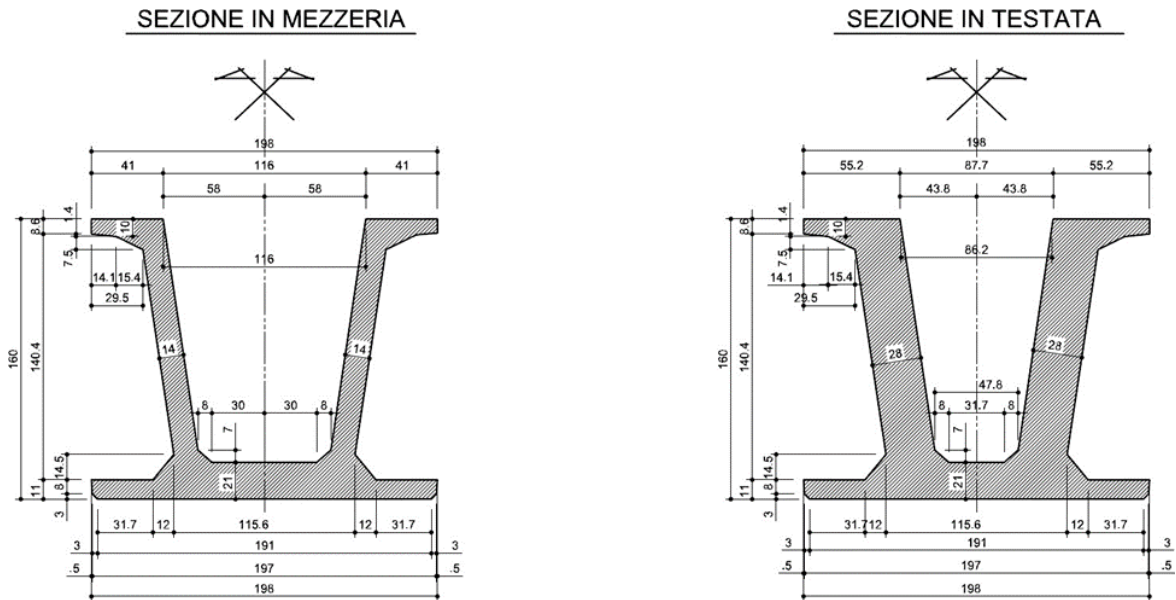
Sezione trasversale trave CIR 198/160/14-28cm
